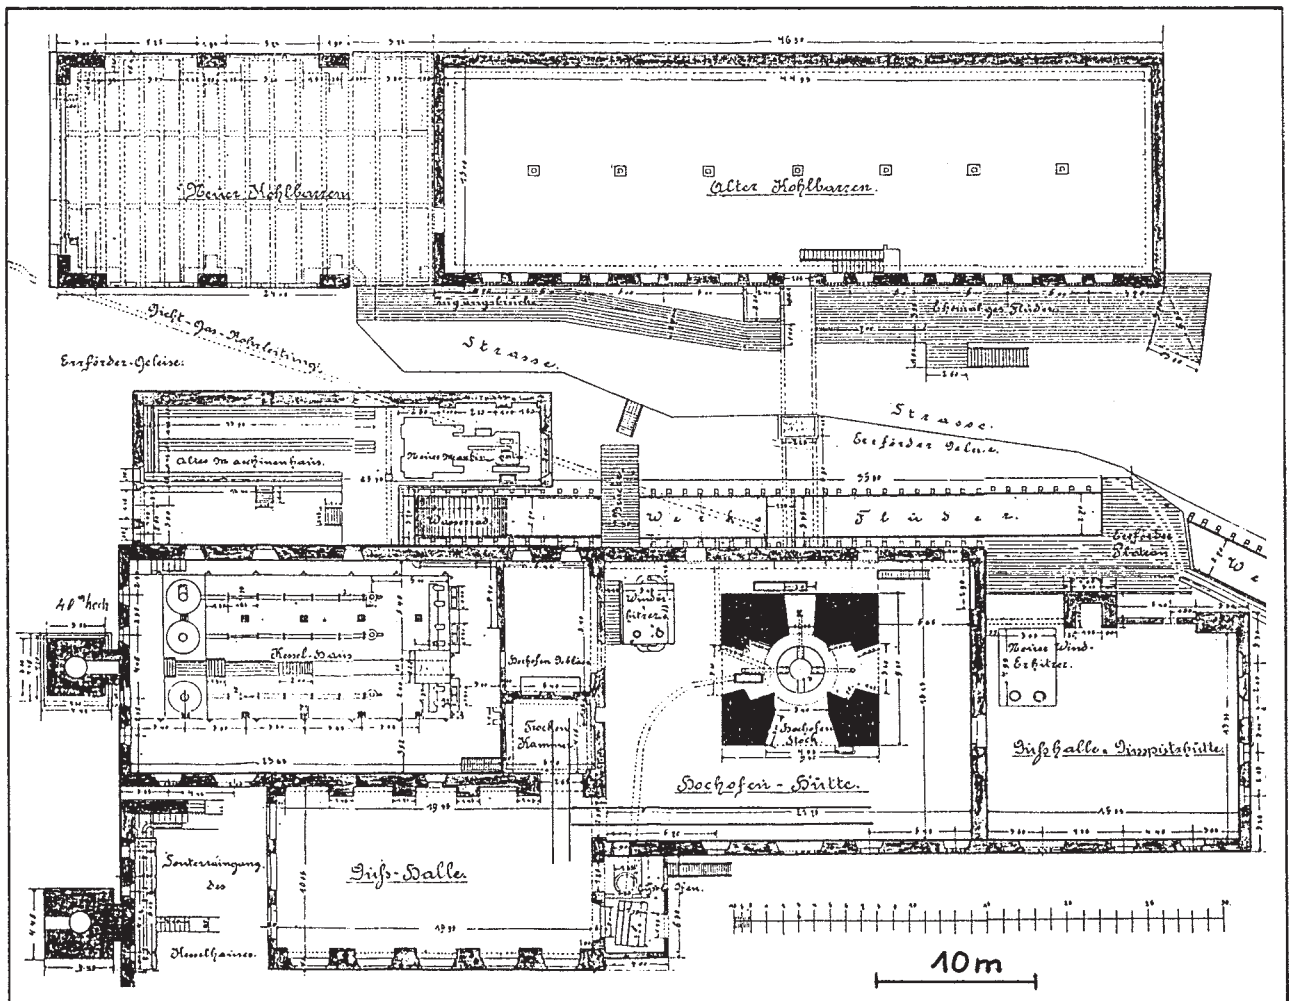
Eisenwerk in Turrach um 1905 nach Auflösung des Bessemerstahlwerkes und Errichtung der Gießerei. Oben: Kohlbarren; unten von links nach rechts: Kesselhaus, Guss-Halle, Hochofen, Guss-Halle und Gussputzerei (ehemalige Bessemerhütte). Plan in den Schwarzenbergischen Archiven Murau.
